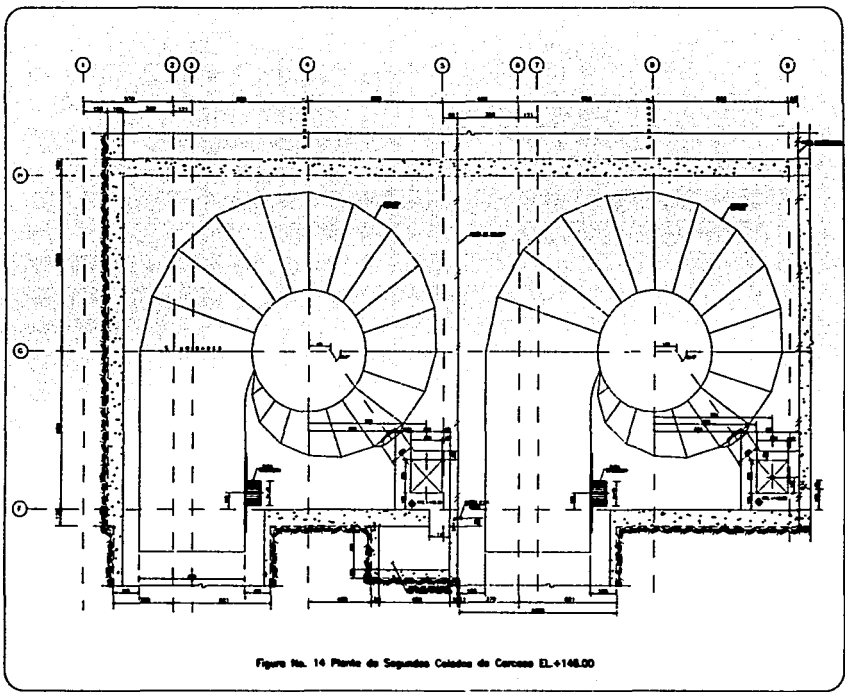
Planta de Segundo Nivel de Carcasa EL.+148.00
